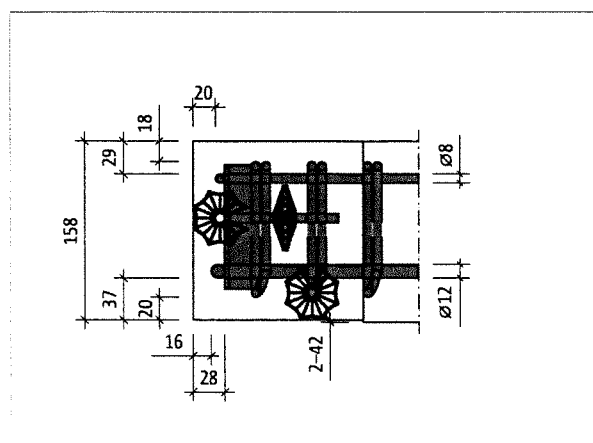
Schöck Tronsole® Typ Z: Seitenansicht einer Auflagerkonsole mit eingebautem Tragelement
